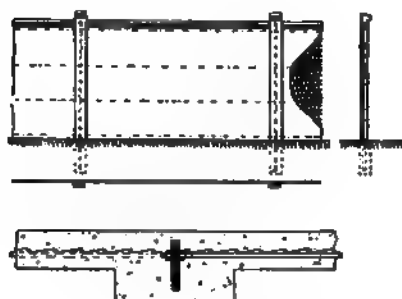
u. 40. Umfassungsmauer mit Streckmetall-Einlage.
